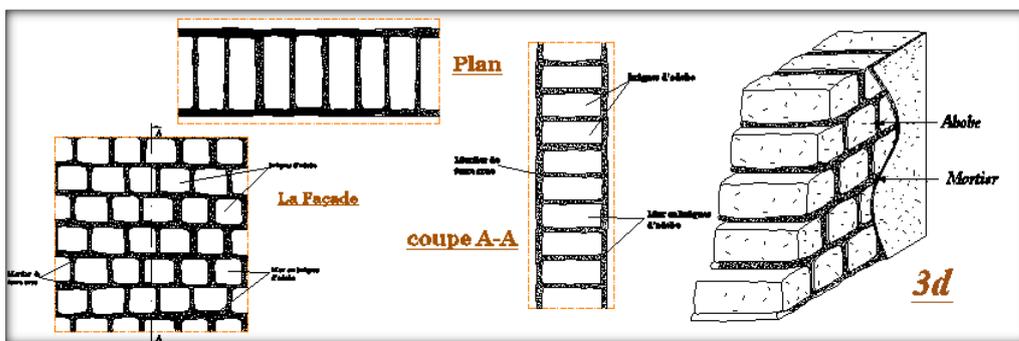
Détails constructifs d'un mur intérieur en brique de terre crue. Source : auteur
